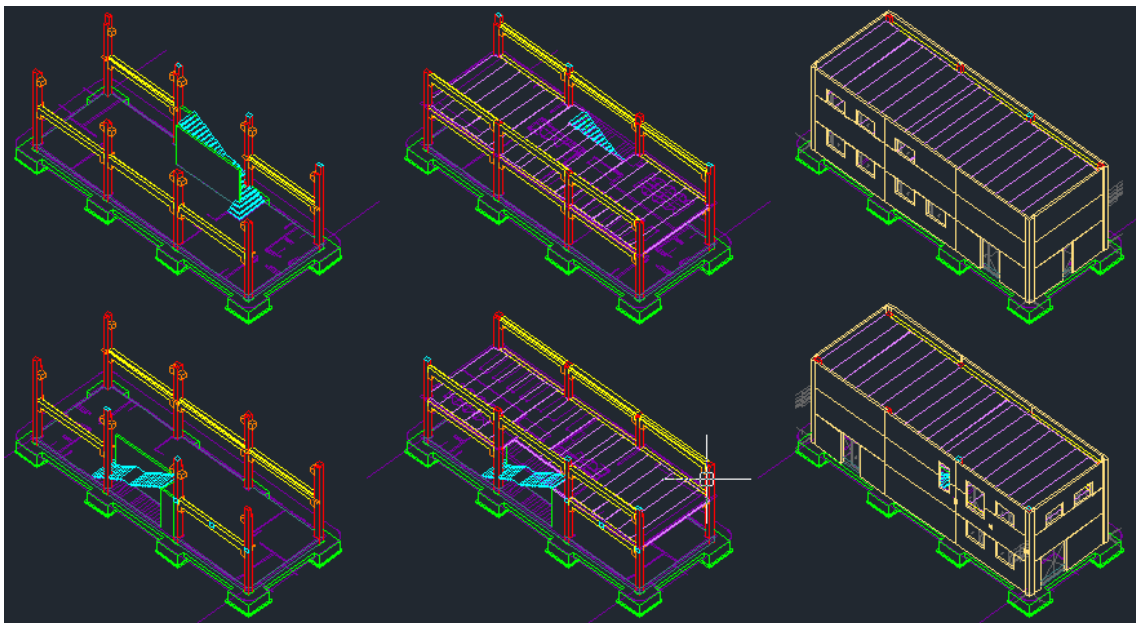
Planos en vista isométrica de la estructura del edificio
